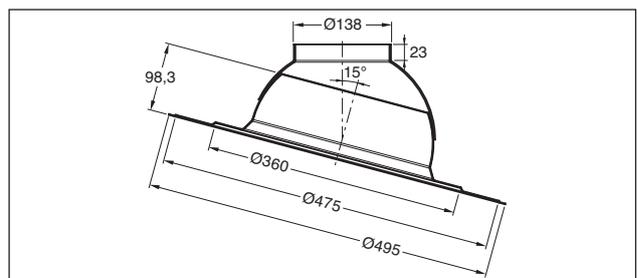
Flachdach-Klebeflansch (Maße in mm)
